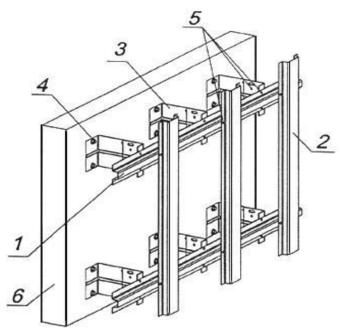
Конструкция каркаса НВФС с перекрестной схемой расположения направляющих
